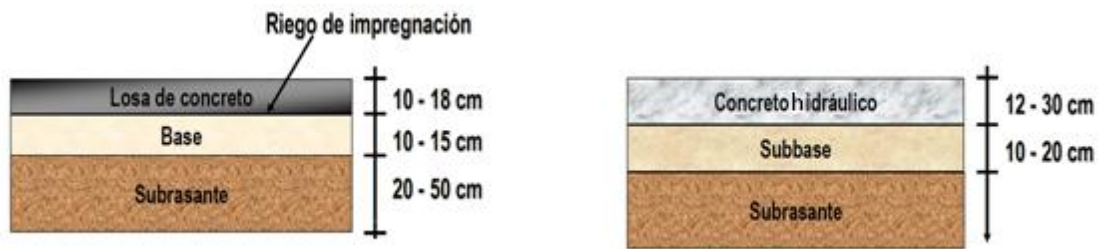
Pavimentos de concreto hidráulico o rígidos.
